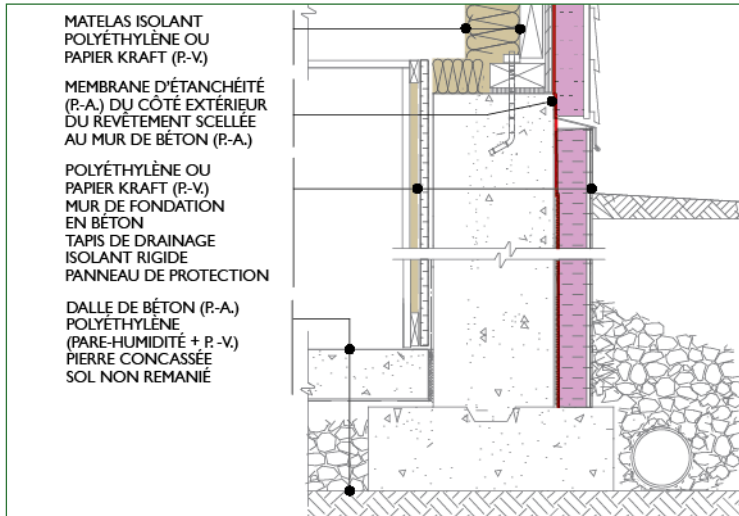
Murs au-dessous du niveau du sol – isolation et étanchéisation à l'air du côté extérieur du mur de fondation
